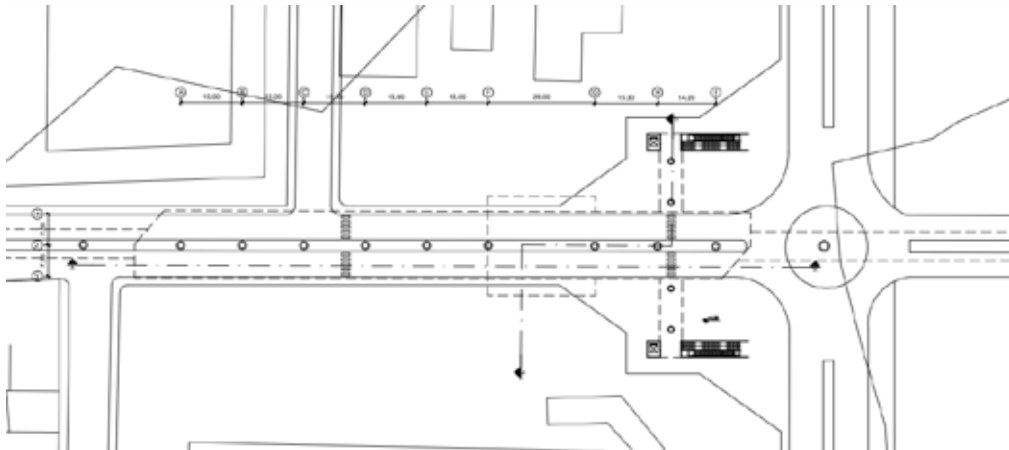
Planta Baja Propuesta Estación Tipo en la Ciudad de Rubio.
